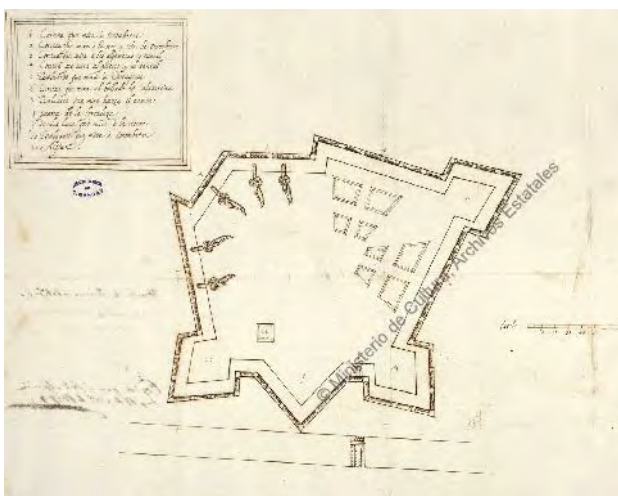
Planta de la fortificación del Fuerte de Trinca-Botijas (Cartagena) 1645 (AGS. MPD, 27, 031)
